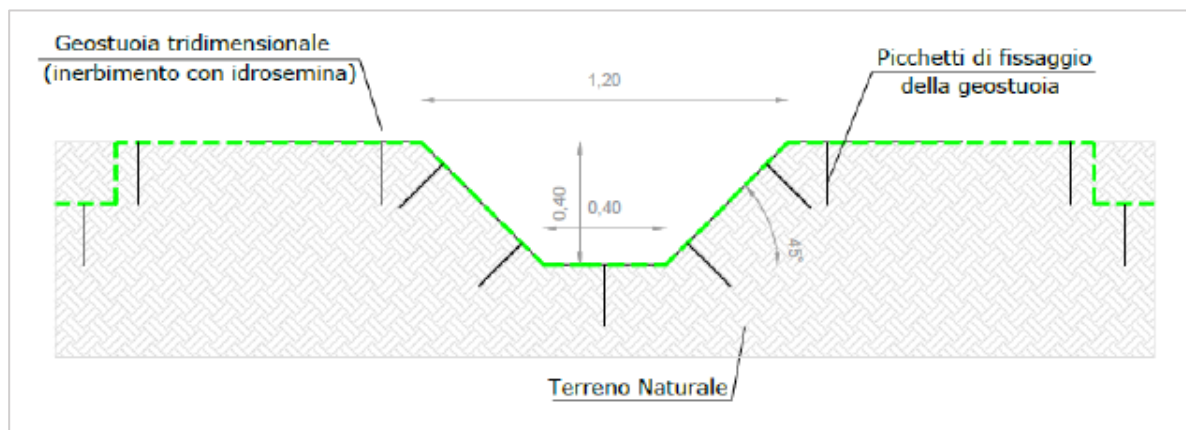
Sezione drenaggio – Canale trapezoidale in terra
